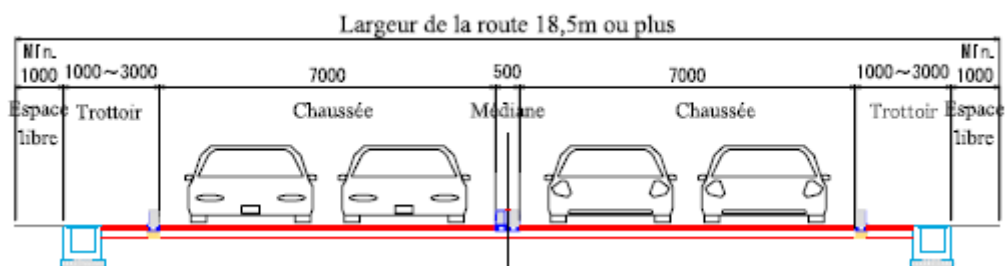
Section standard de la route nord-sud (R-1)
